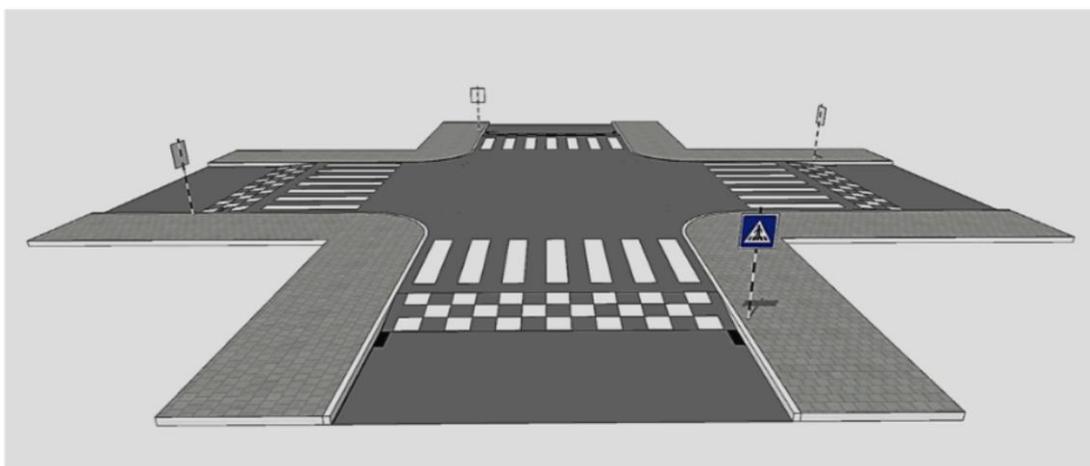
Planta do cruzamento elevado em 3D (Fonte: Elaboração própria)
